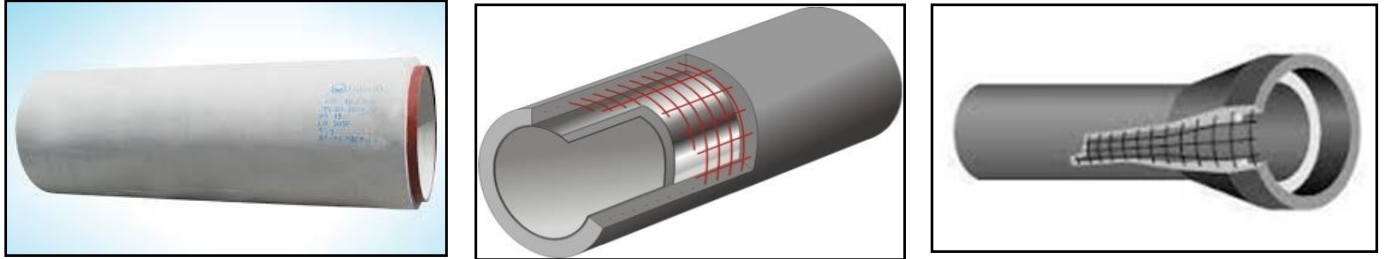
Aptitude aux techniques de pose sans tranchée des conduites en béton
